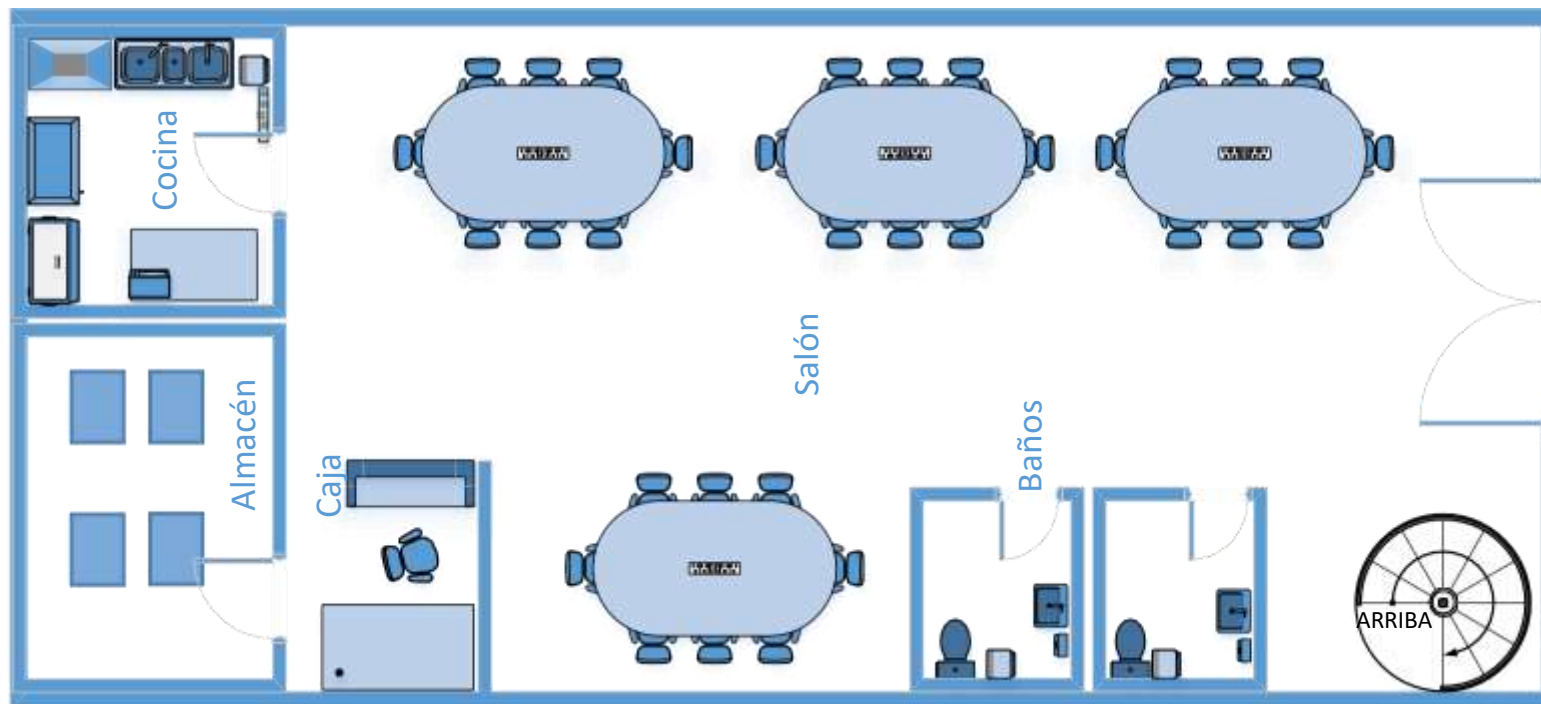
Distribución de la planta baja, Fuente: Elaboración propia
